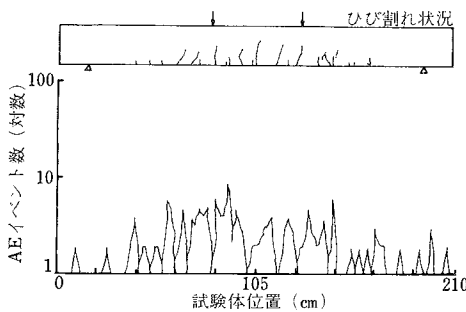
試験体のひび割れ状況と位置標定(Pmaxの40%時)
